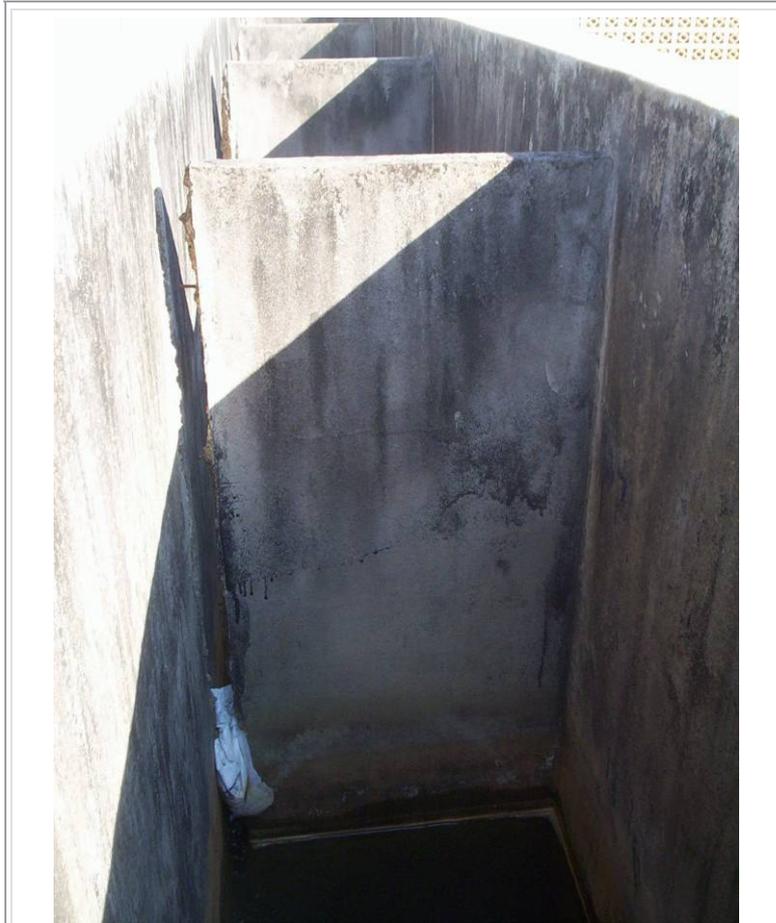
Detalhe das rachaduras nas paredes das chicanas verticais
